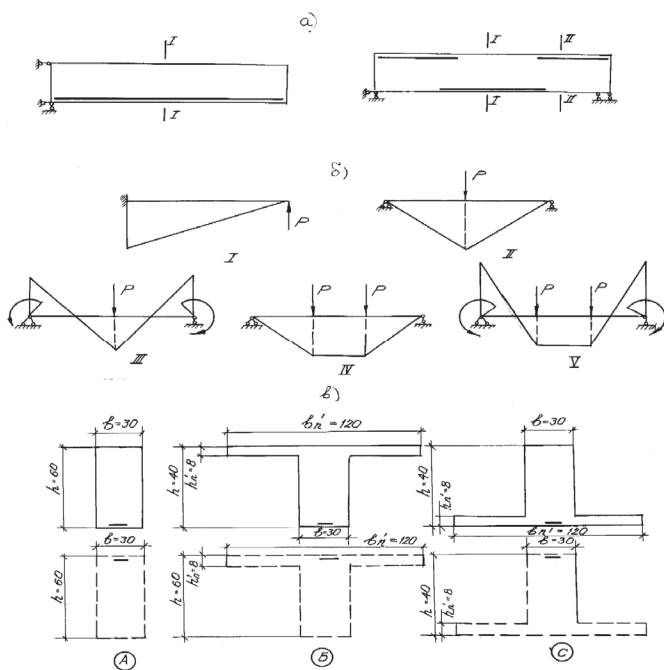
а) схеми армування; б) схеми навантаження; в) форми поперечного перерізу
